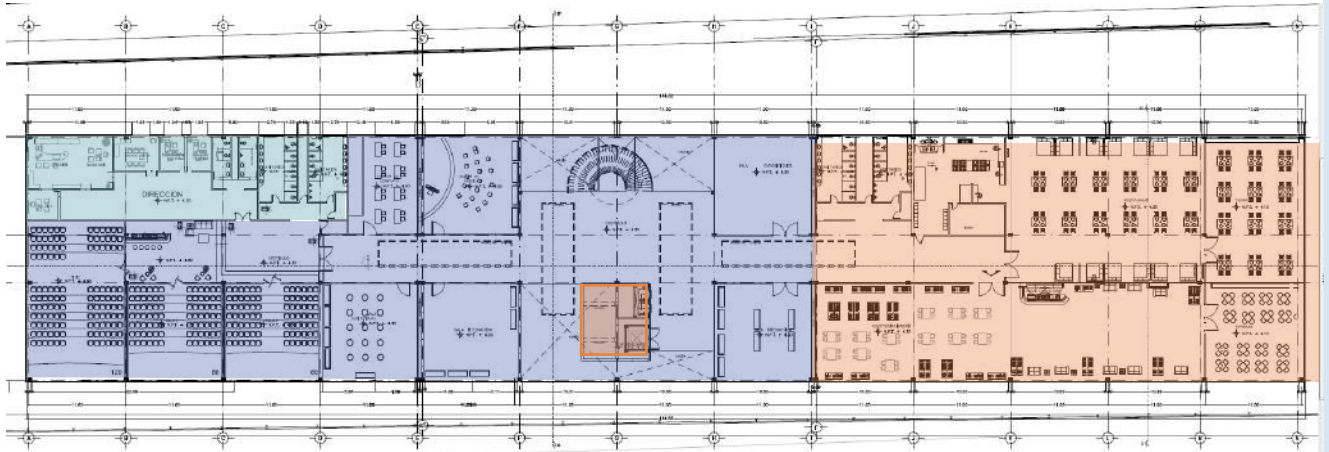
[PLANTA BAJA, SERVICIOS](#)
